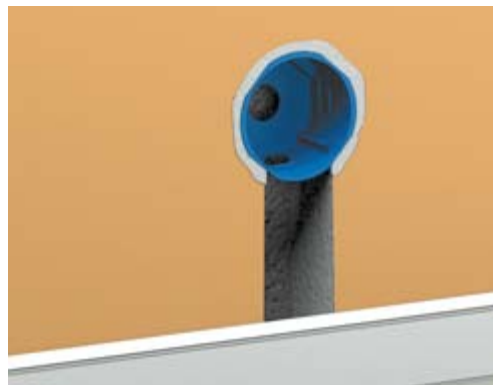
Шаг двенадцатый: через несколько часов, когда штукатурка окончательно высохнет, края шлифуются — коробка готова к установке
